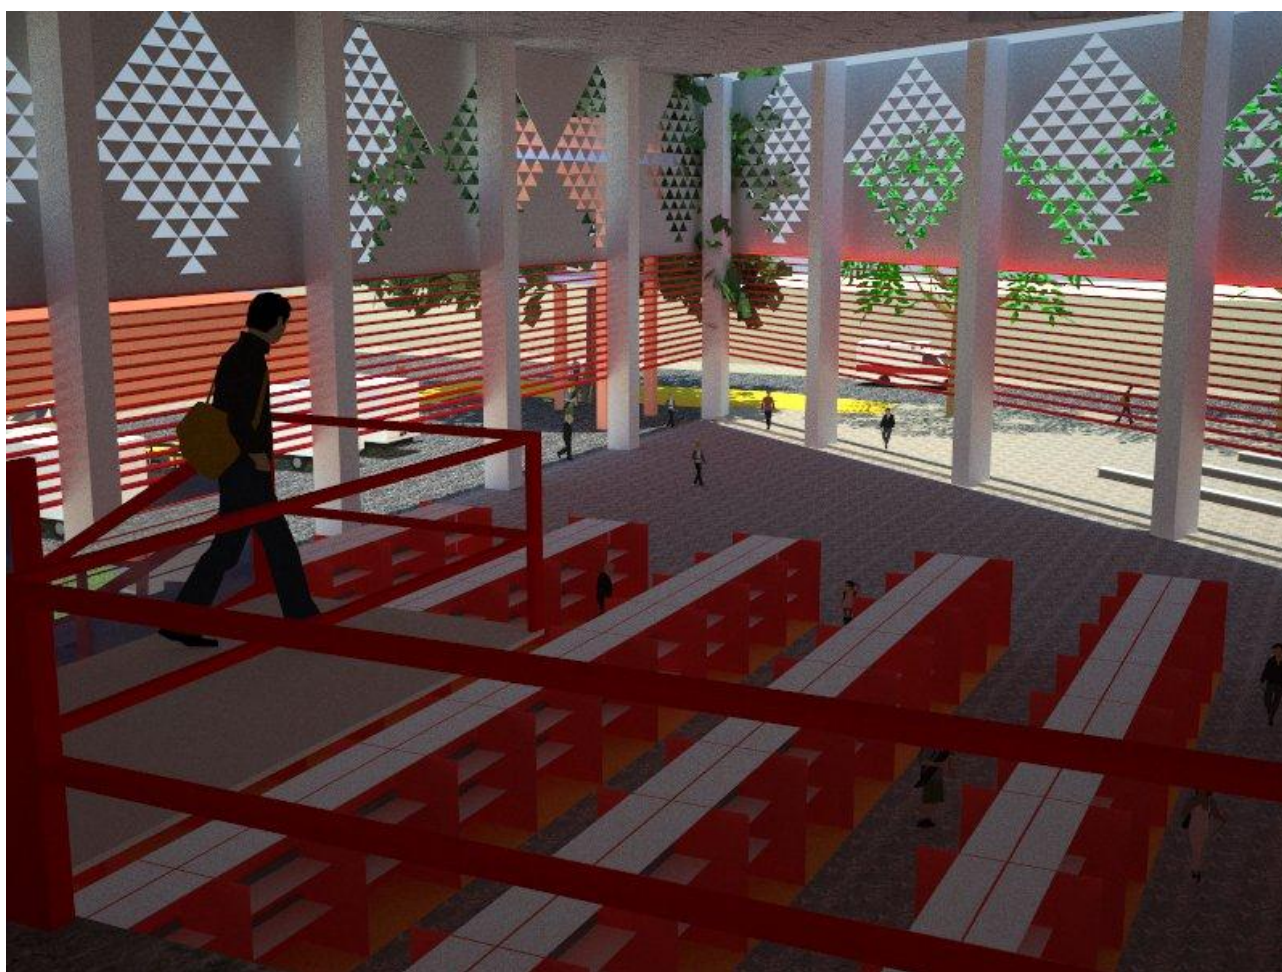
Vista da área de feira a partir da passarela do 1º pavimento.
